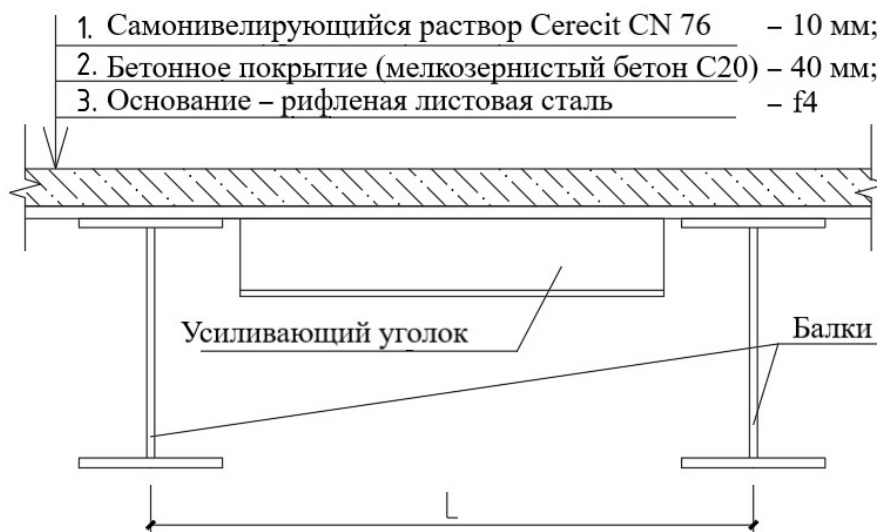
Детали конструкции с примыканием бетонного покрытия
